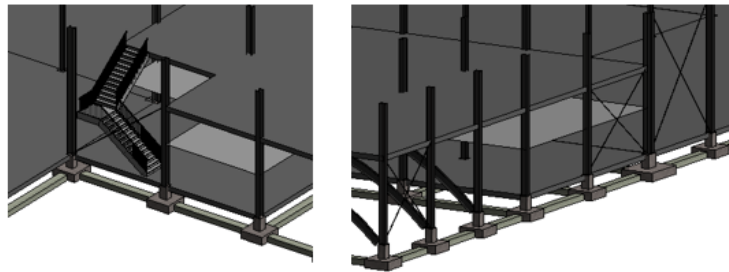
Resultado del techo en la primera planta, en color claro.
